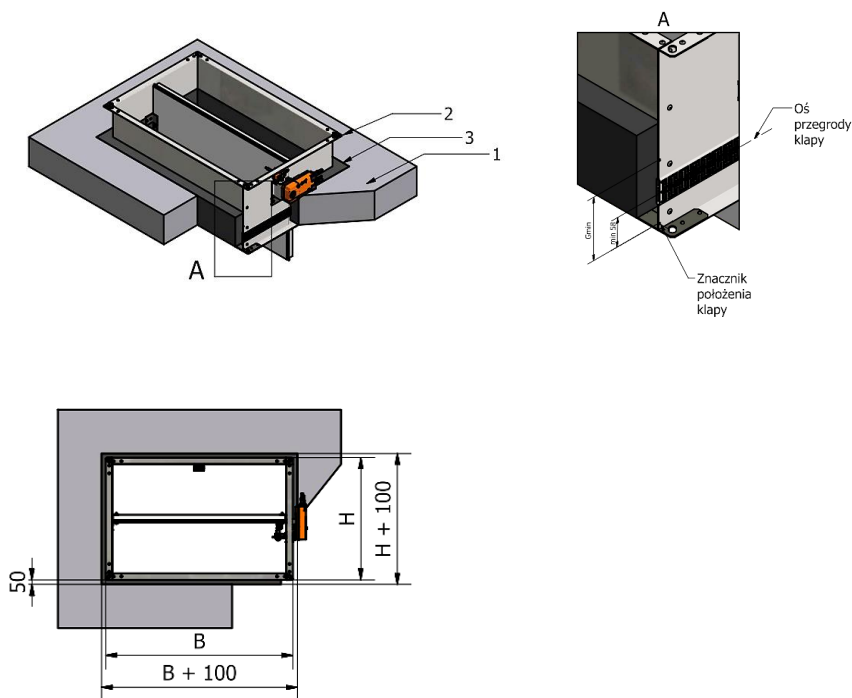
Przykład montażu kłapy V330M w ścianach betonowych lub murowanych
